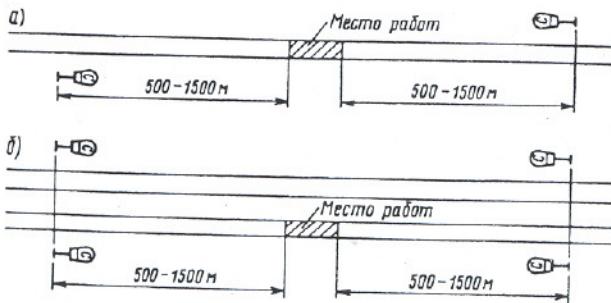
Схема ограждения мест производства работ на перегоне переносными сигнальными знаками "С":
